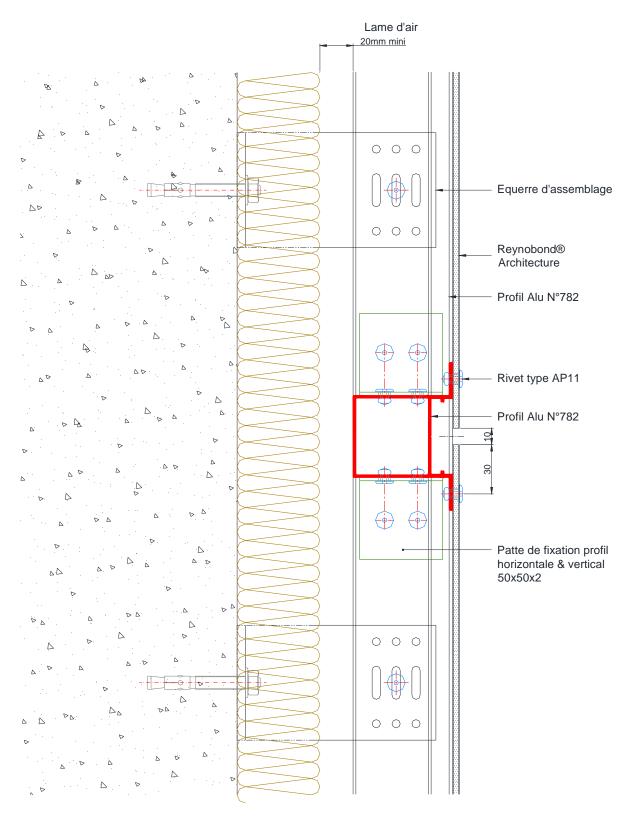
Joint horizontal - Coupe verticale – Système riveté RV 60 4c
